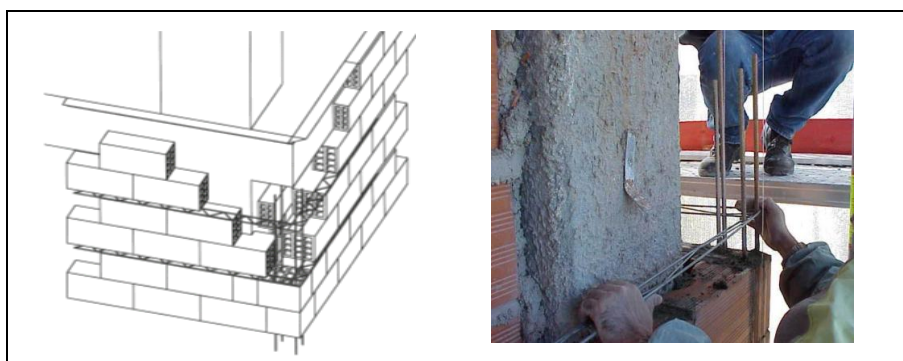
Painéis de alvenaria com juntas horizontais armadas
